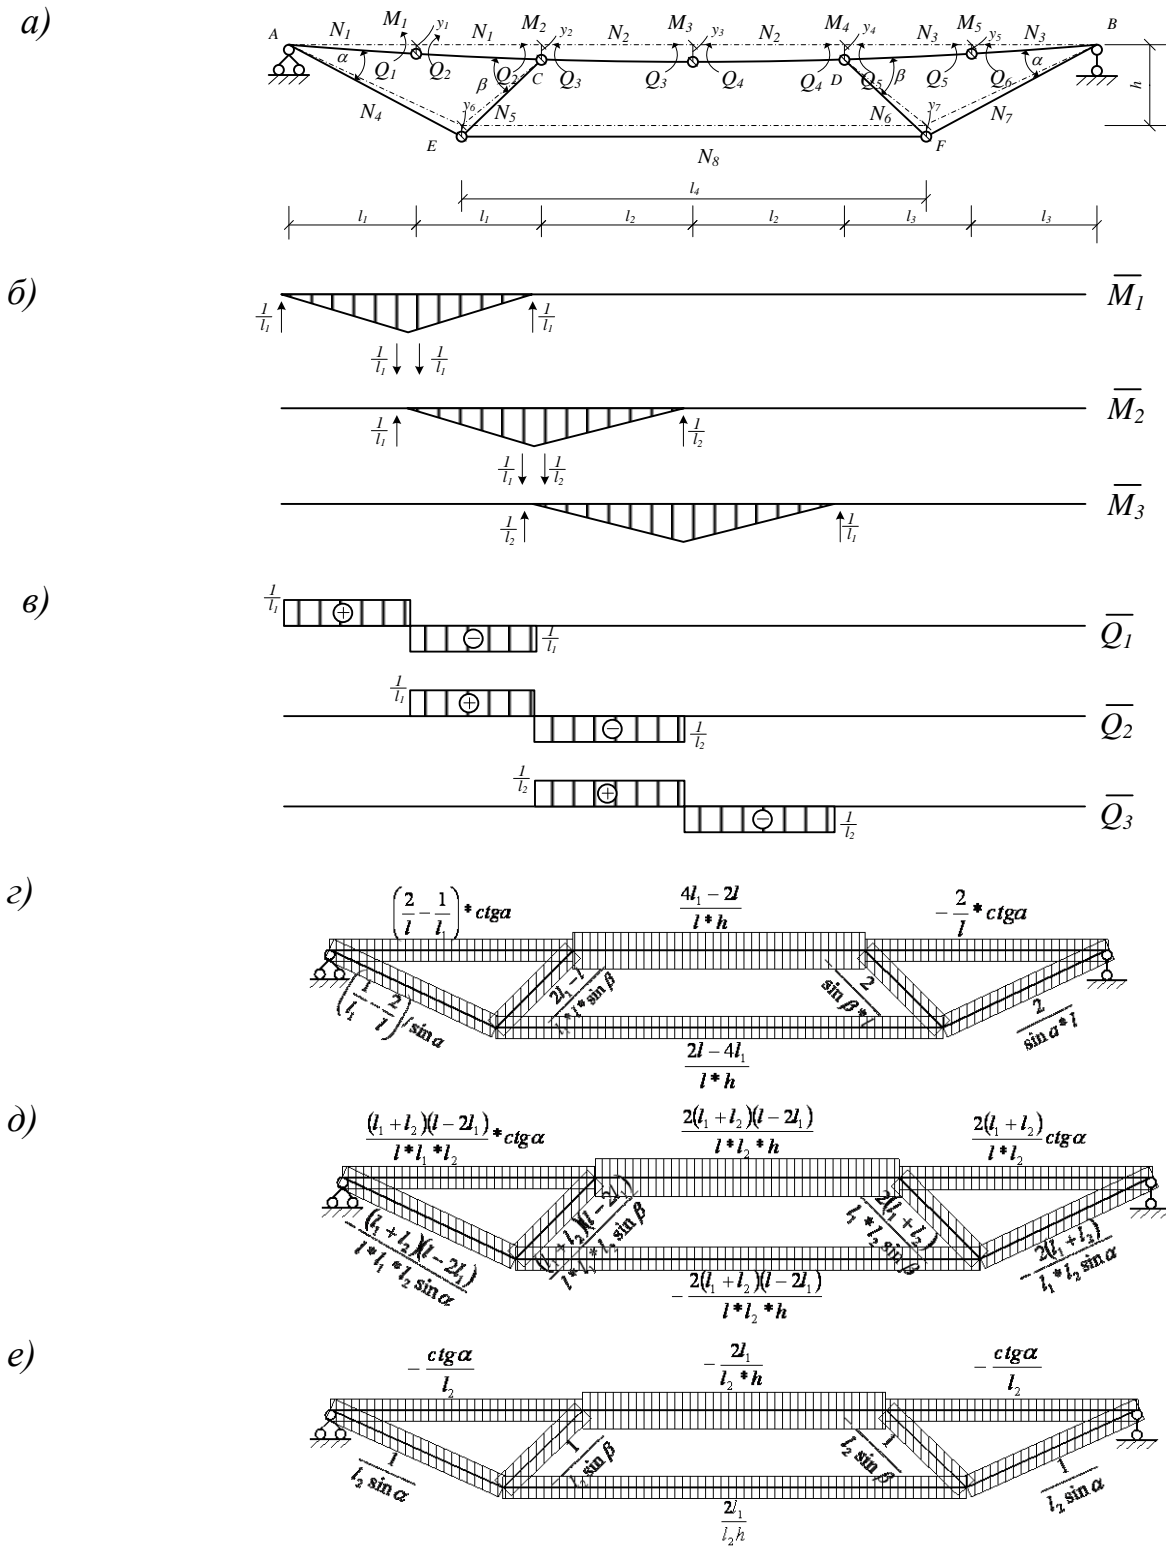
Розрахункова схема комбінованої металевої шпренгельної конструкції:
